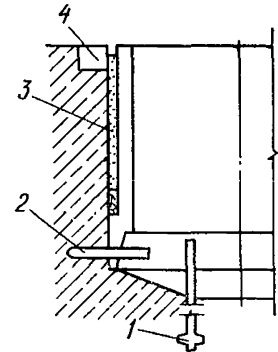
Схема устройств для закрепления колодца против всплывания
